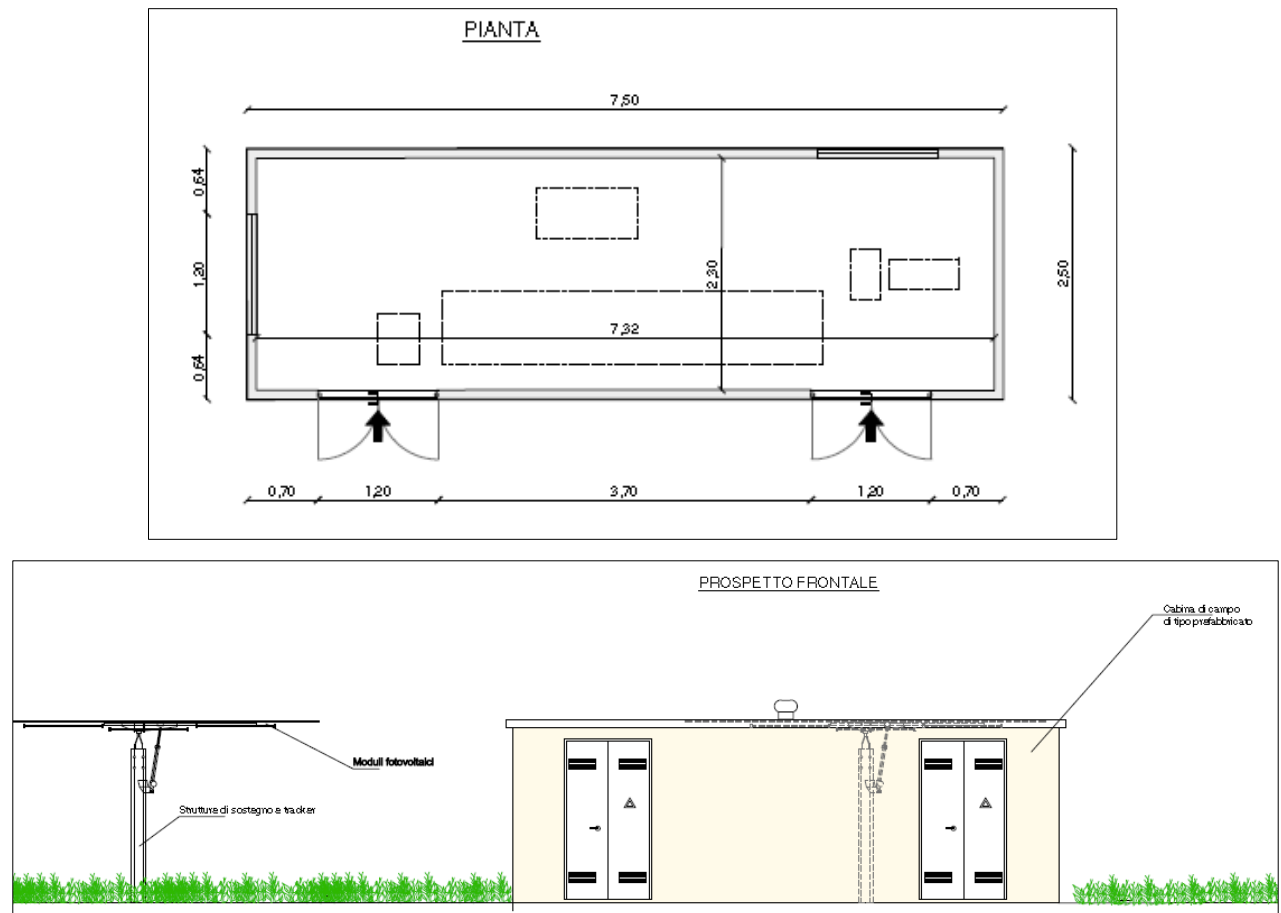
Pianta (*sopra*) e prospetto frontale (*sotto*) delle cabine di campo di progetto
